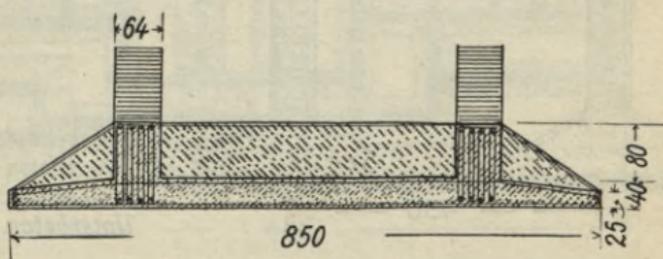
Platte in Eisenbeton für ein Turmfundament.
